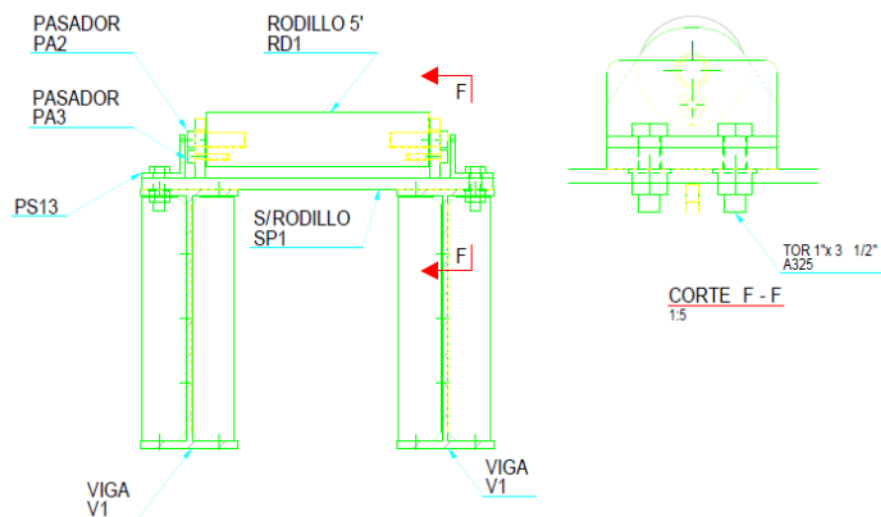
Elementos de apoyo para ensayos – Fuente Planos de diseño Estahl Ingeniería
